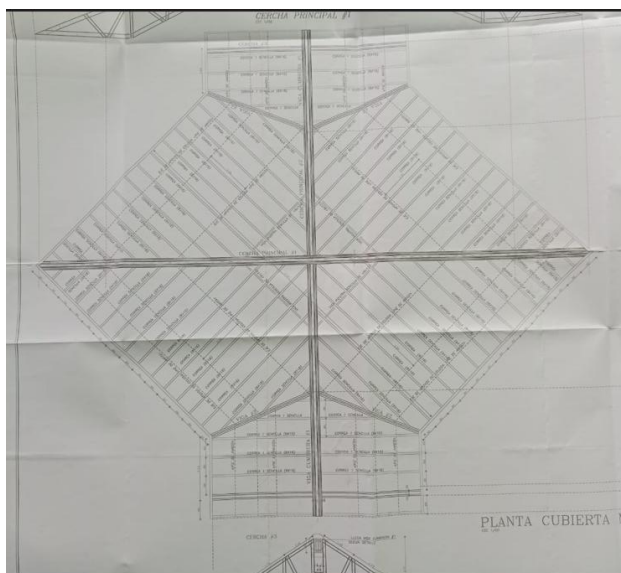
Planos Bloque 3 Aula Ambiental CRQ sede Armenia
